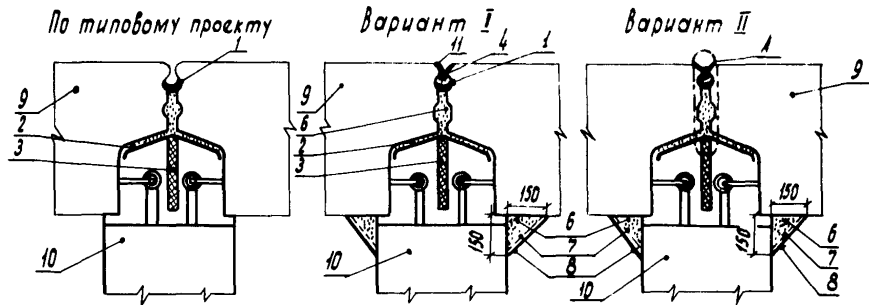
Герметизация и утепление открытого вертикального стыка панелей наружных стен (на примере домов серии 1ЛГ-602):
